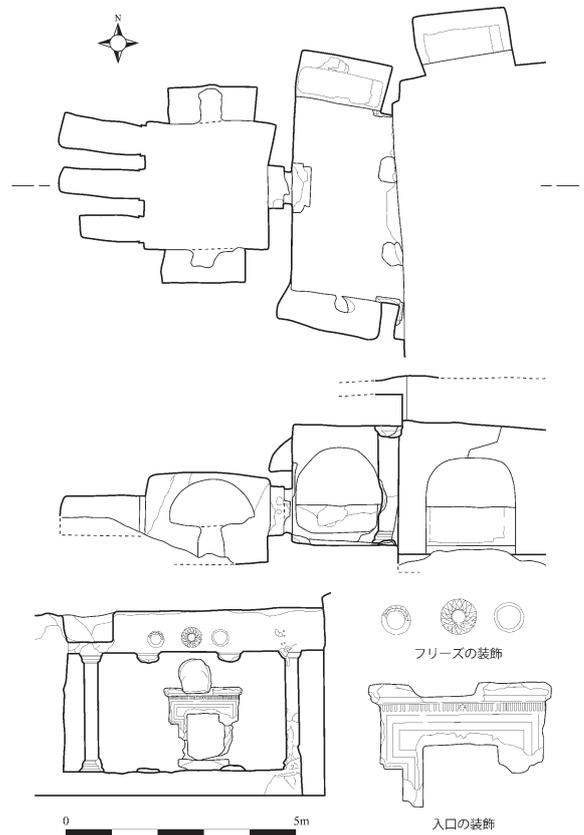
Tomb 2 平面図 (上)、断面図 (中) 及び立面図 (下)
